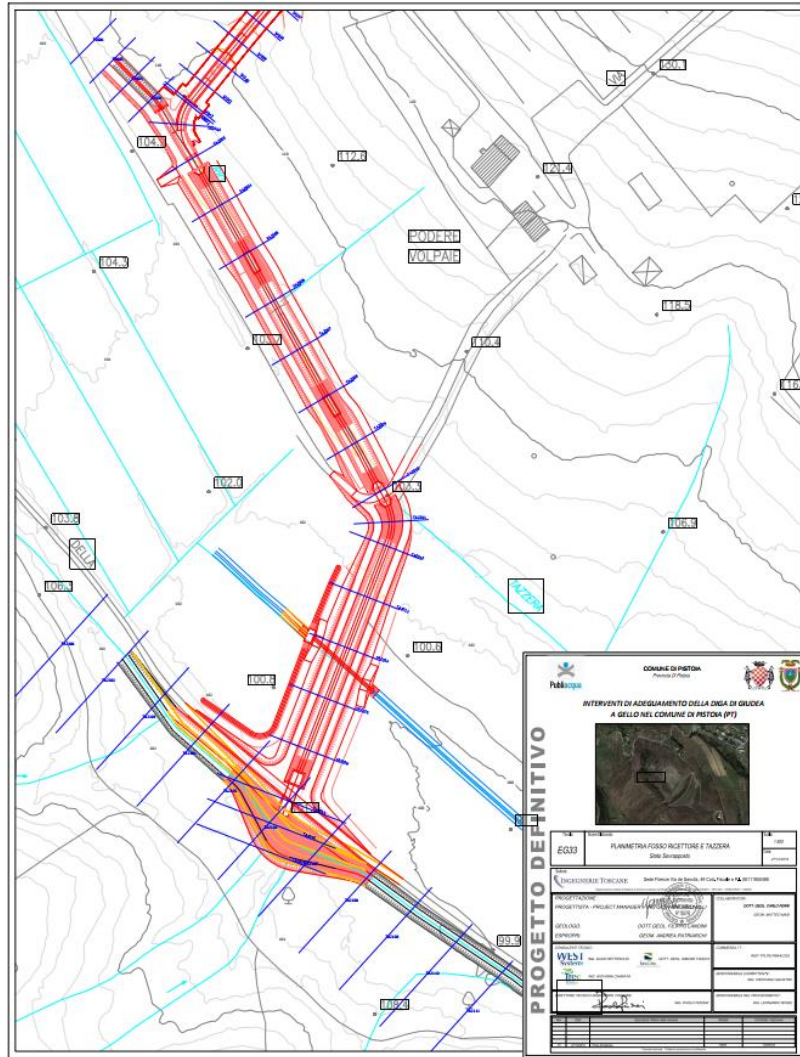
Planimetria del fosso recettore, stato sovrapposto
